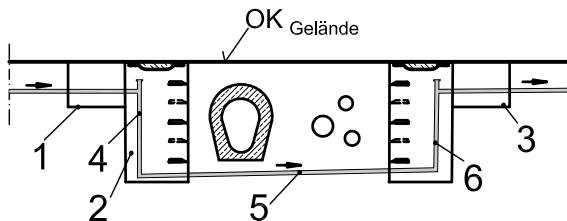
Senkrechte Dükeräste, Vorzugsvariante (Prinzipskizze)
